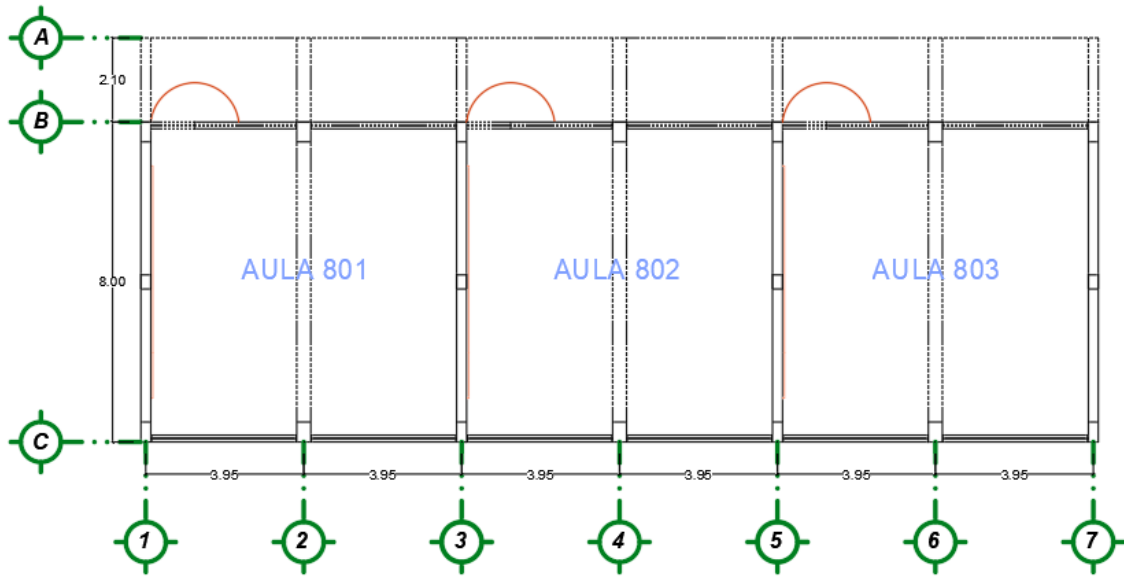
Planta típica del pabellón 8. Fuente: Elaboración propia
